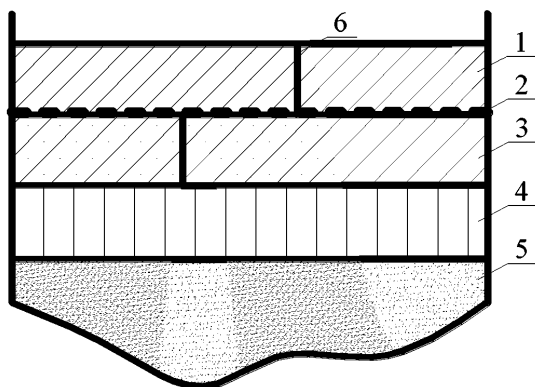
Усиление цементобетонного покрытия методом наращивания:
